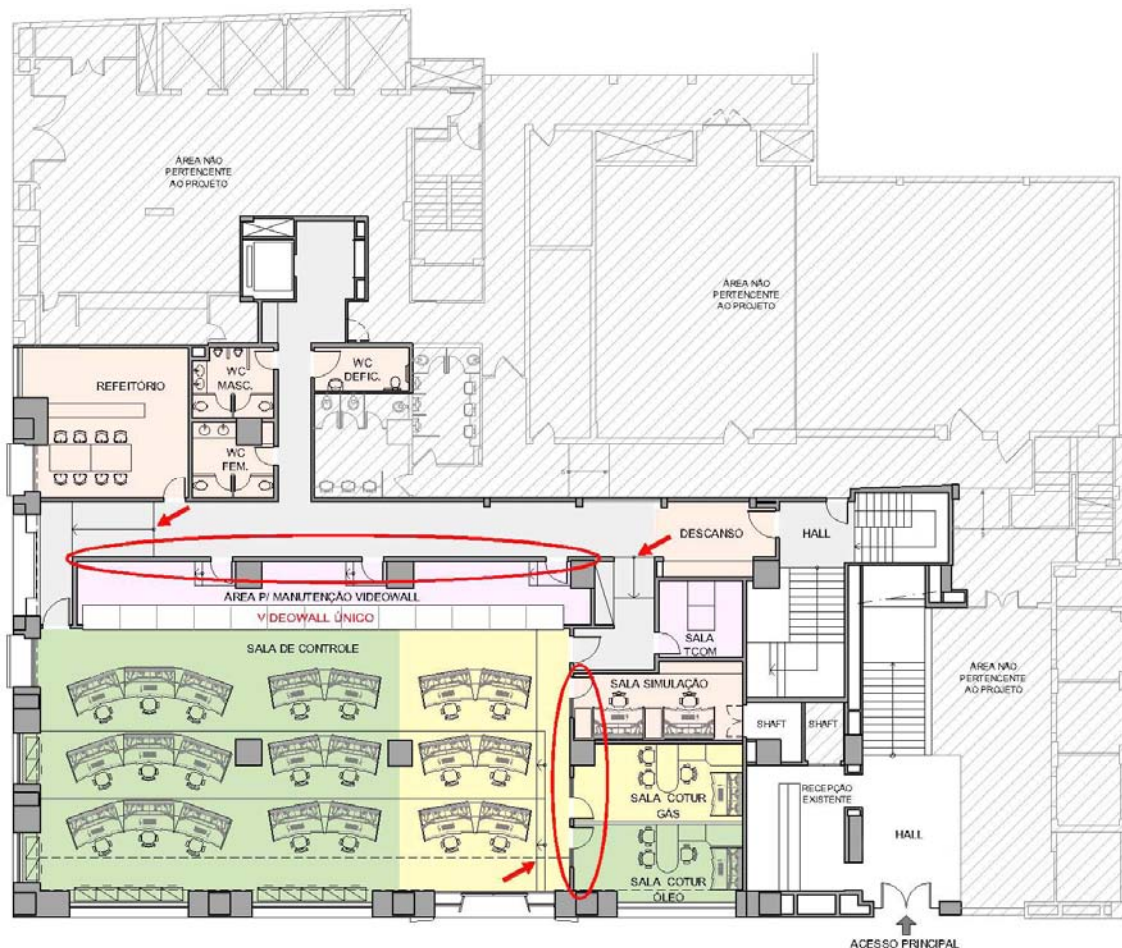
Planta baixa pavimento térreo: layout apresentado como revisão do *milestone 2
